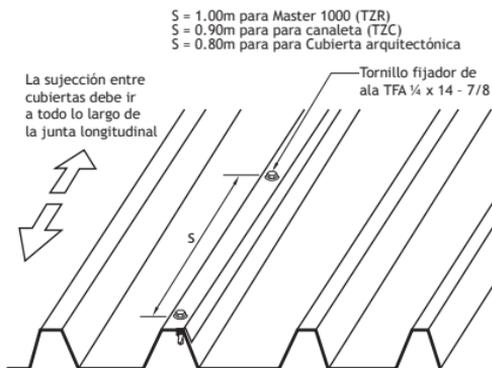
Detalle de la instalación del tornillo fijador de ala en el traslape longitudinal
